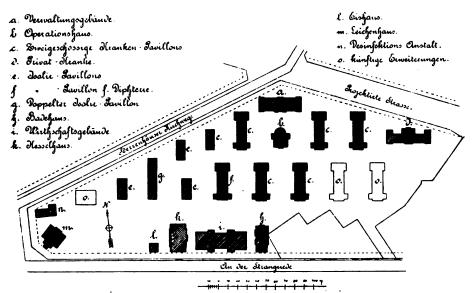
Neues Städtisches Krankenhaus an der Strangriede zu Hannover. Lageplan.
